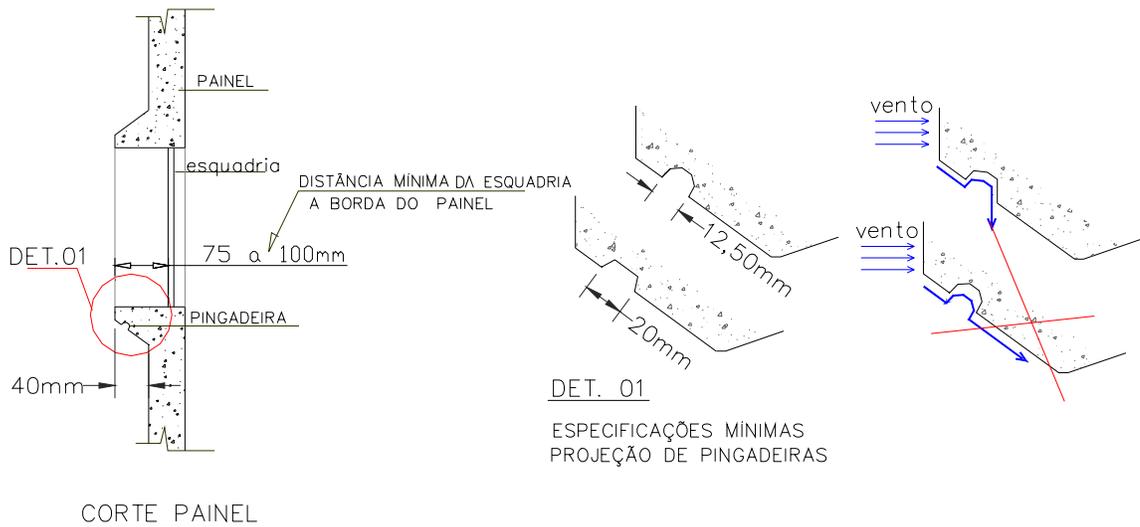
Detalhes construtivos das pingadeiras e peitoris (PCI, 1989)
